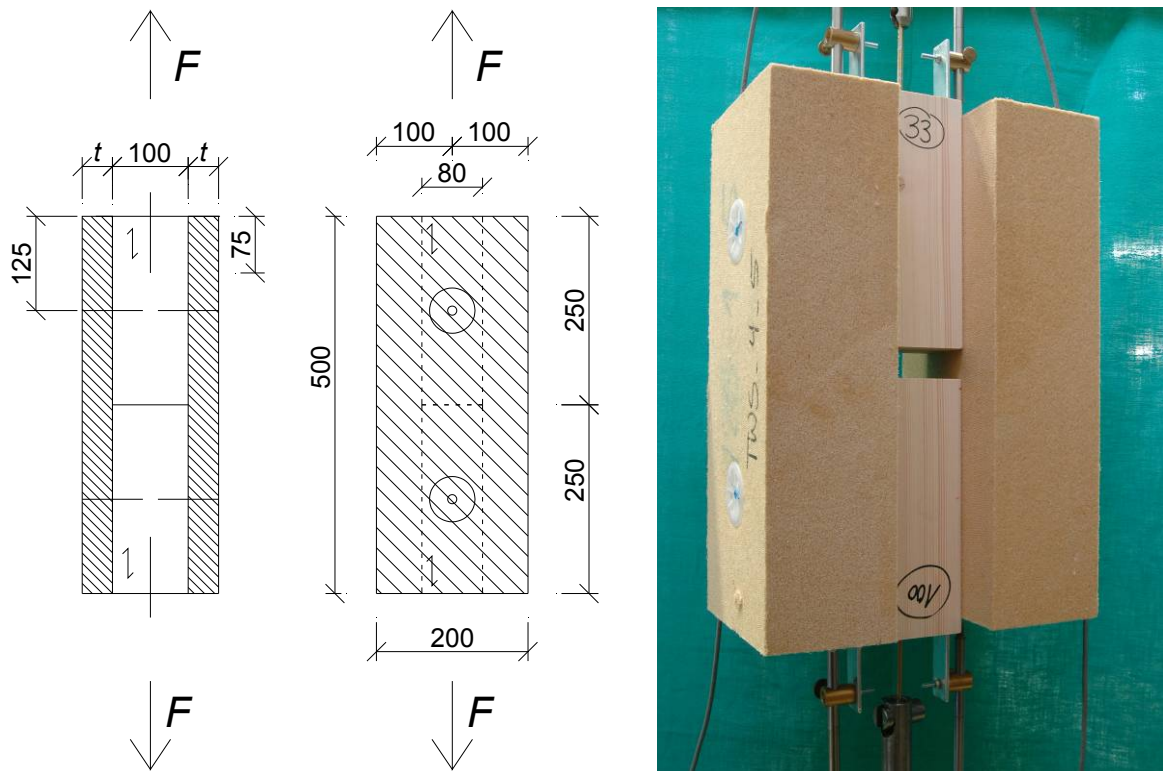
Versuchskörper für Versuche mit Schrauben mit Haltetellern (Maße in mm)
